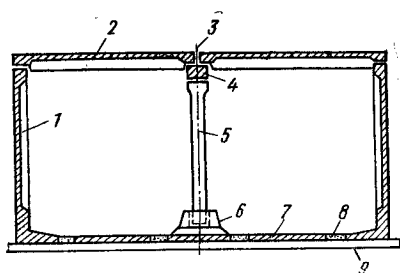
Двухсекционный тоннель с угловыми стеновыми элементами и промежуточными стоечными опорами
